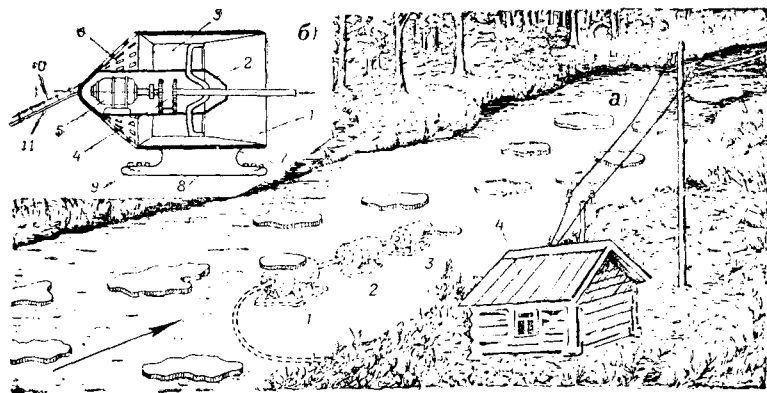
Схема «Подводно свободнопоточной» ГЭС: а—общая схема установки; 1, 2 и 3—агрегаты; 4—помещение распределительного устройства; б—разрез по агрегату. 1—кожух; 2—лопасть турбины; 3—перегородка; 4—редуктор; 5—генератор; 6—решетка; 7—стопка; 8—плита; 9—грузы; 10—трос; 11—кабель
